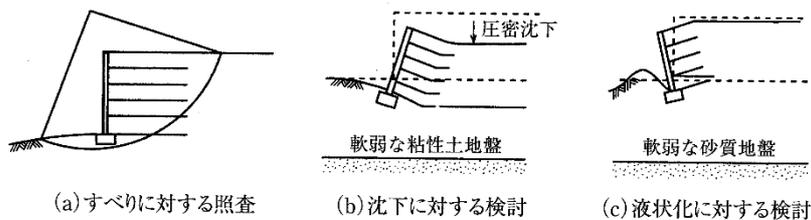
全体としての安定性に対する検討項目⁸⁾
